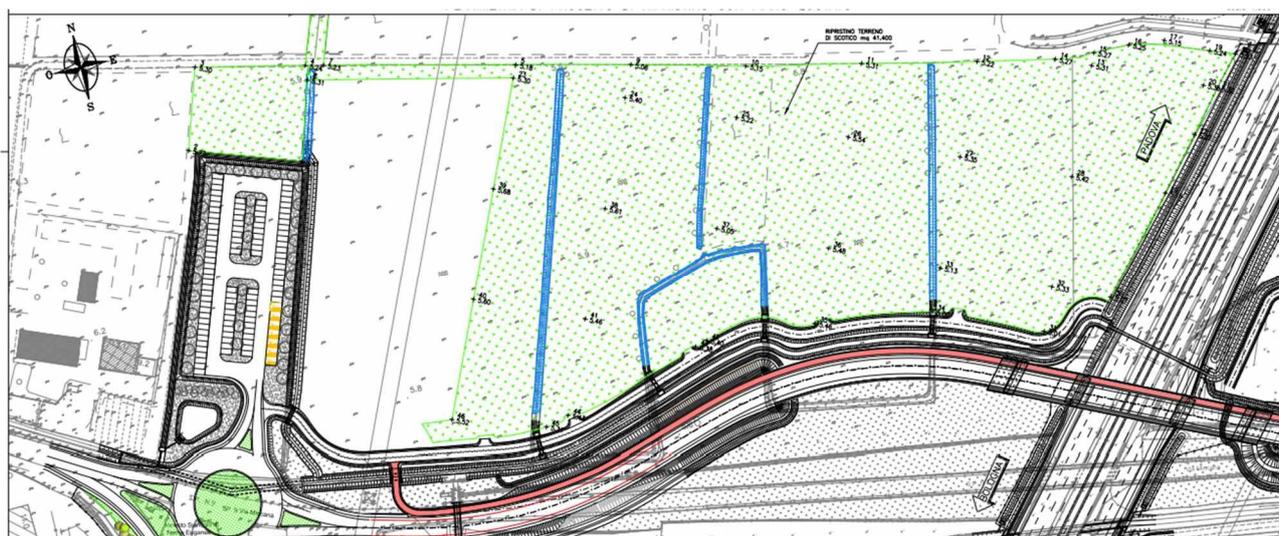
er Parcheggio di Terme Euganee nell'ambito area cantiere CB01 ripristinata (da elab STD7300)
